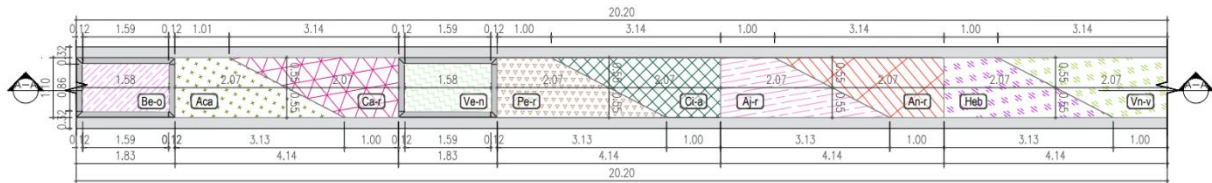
Detalle en planta de la jardinería de la FPM en estaciones
